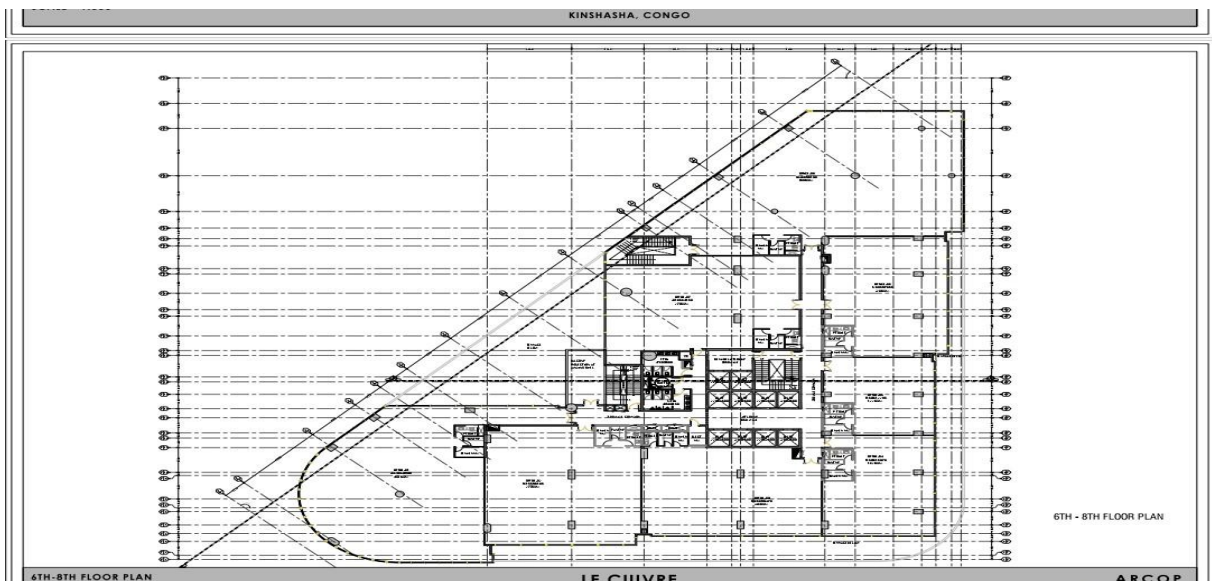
Plan présentant les 6^e, 7^e et 8^e niveaux.
